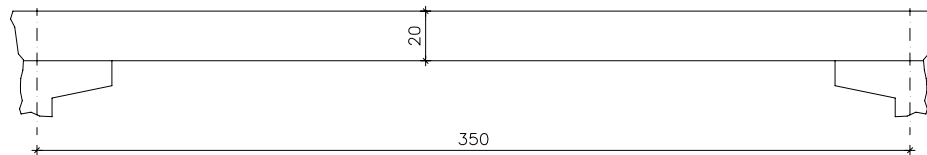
Esquema de Losa, Acceso Sur Tramo Soterrado
